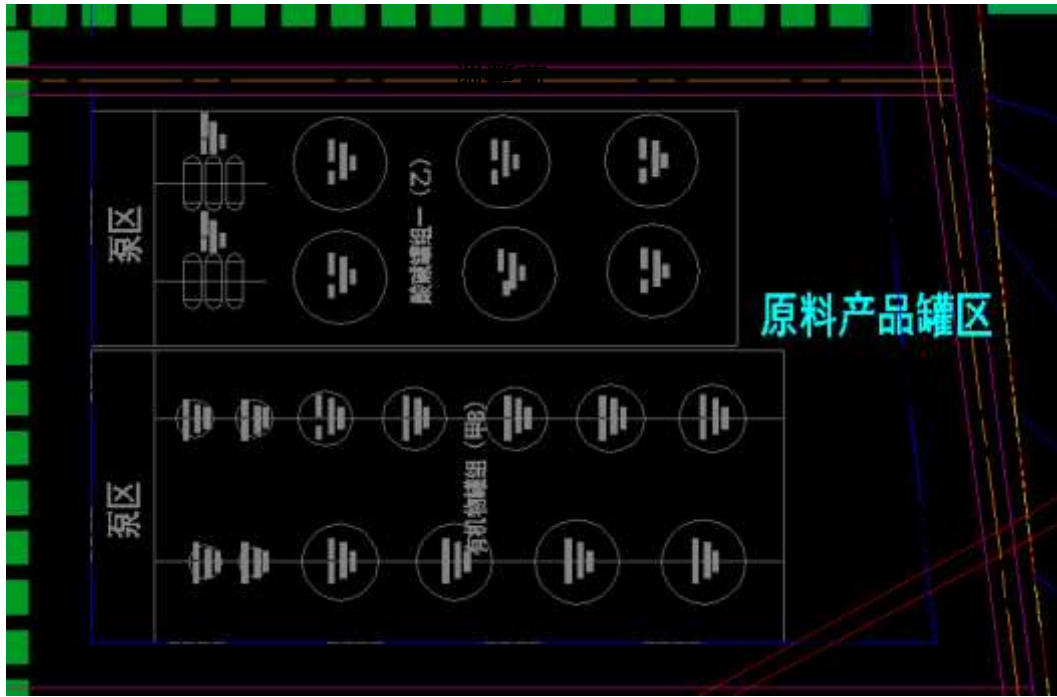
本项目环境风险潜势调整前后的罐区局部平面布置图
